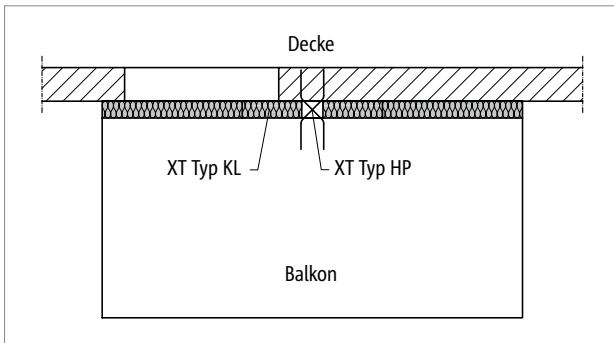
Schöck Isokorb® XT Typ KL: Balkon frei auskragend; optional mit XT Typ HP bei planmäßigen Horizontallasten (z. B. geschlossene Brüstungen)
